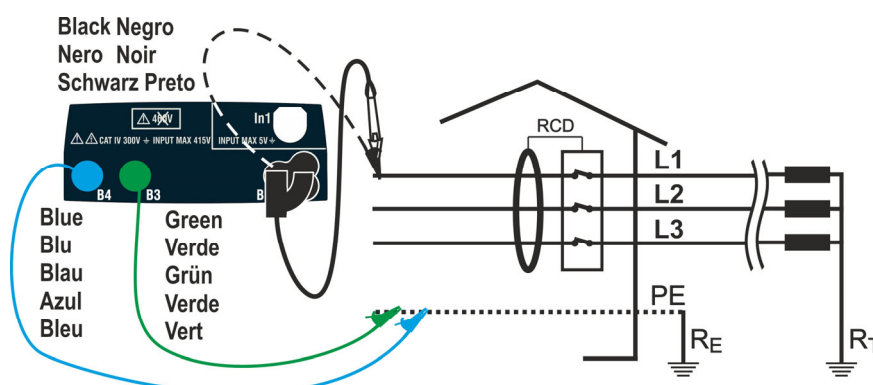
Ligação para um sistema Trifásico L1-L2-L3-PE (sem N) com cabos únicos e cabo remoto
